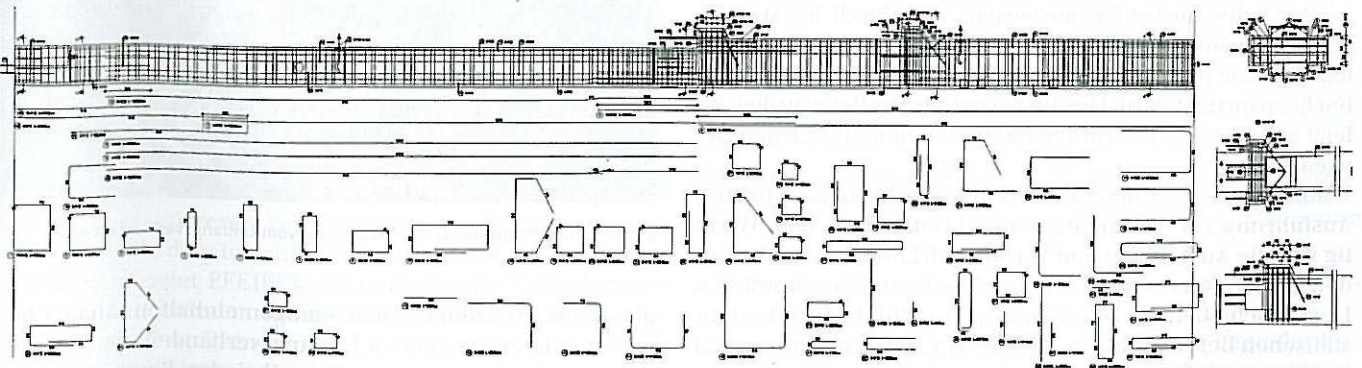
Ausschnitt aus einem Bewehrungsplan einer typischen Hallenstütze
